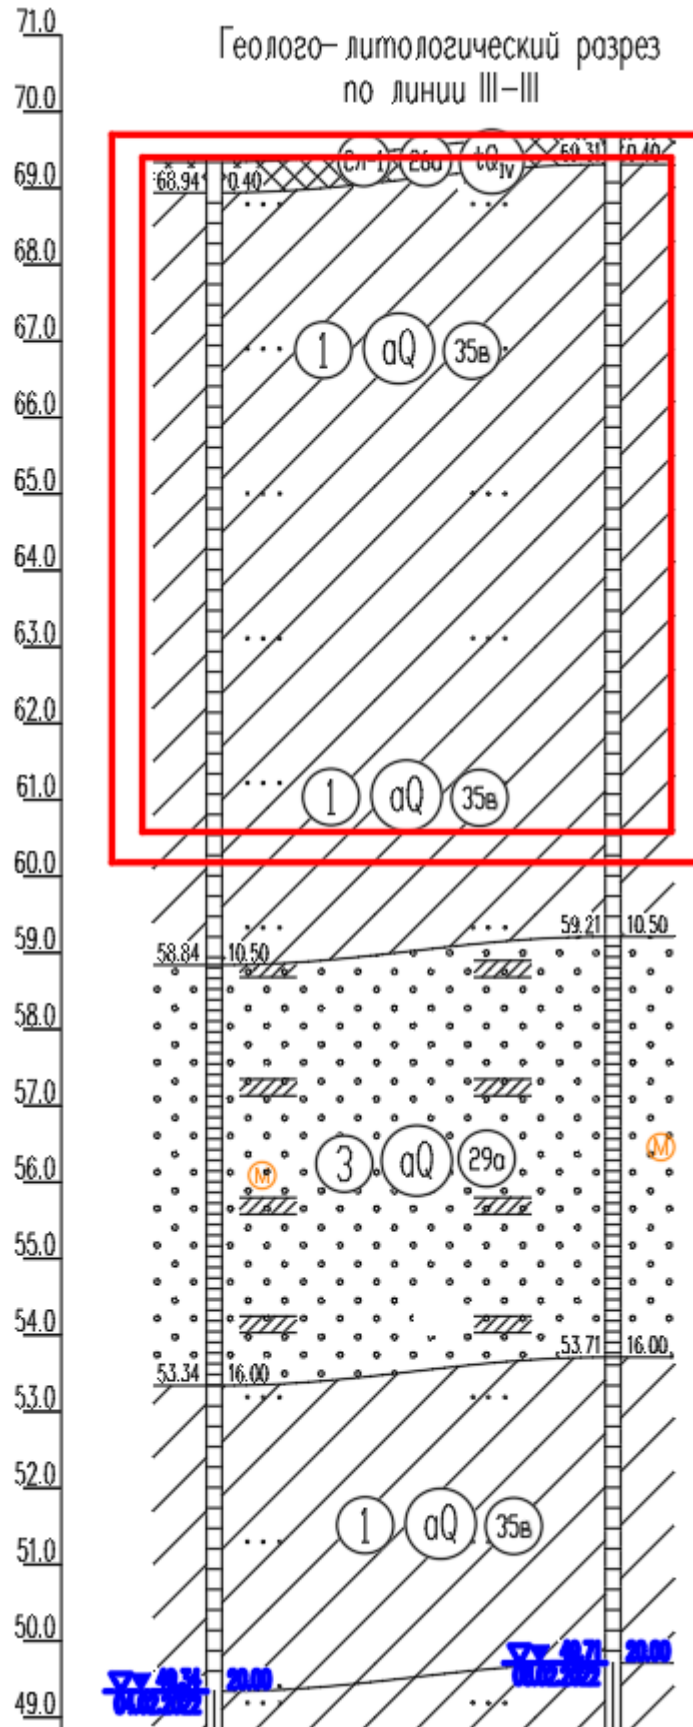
Схема расположения грунта под подошвой фундамента (отм. +61,235 (-8,815) – отметка подошвы фундамента) в системе ГРУНТ
